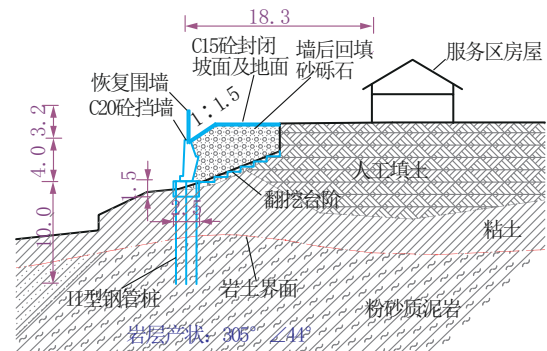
钢管桩+联系梁作为基础,联系梁上再修筑挡墙方案
